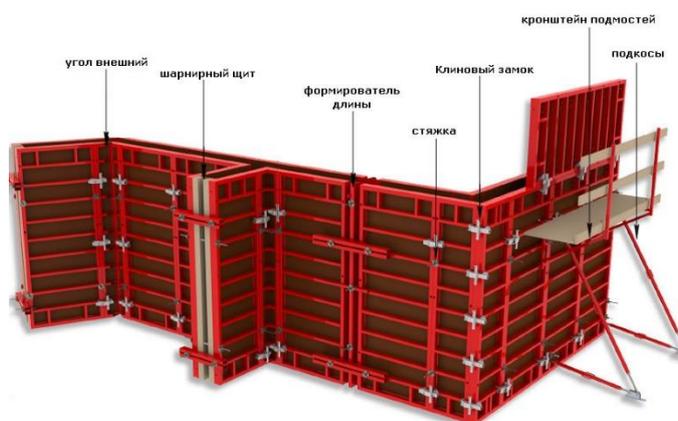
Крупнощитовая опалубка стен с подмостями
